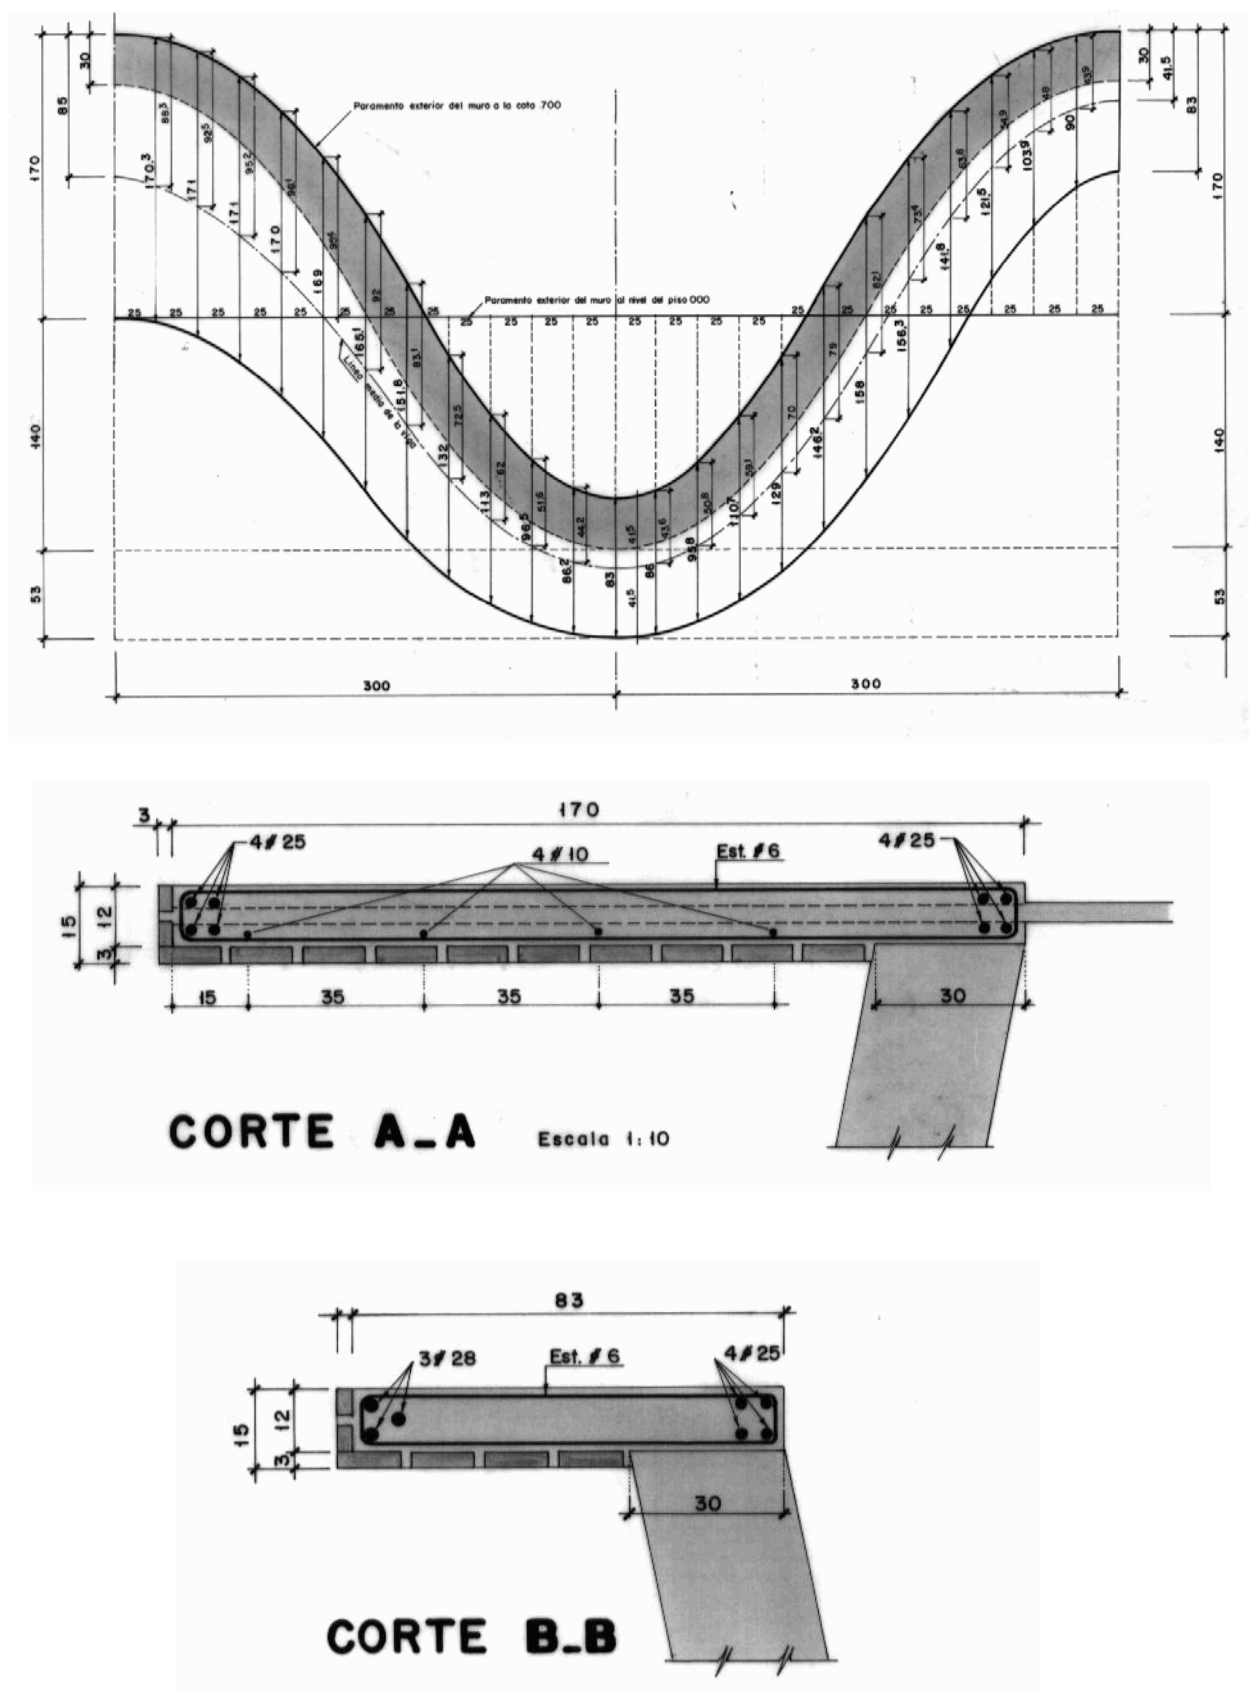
Detalhes construtivos de Atlántida: sistema de reforço da viga de borda.
